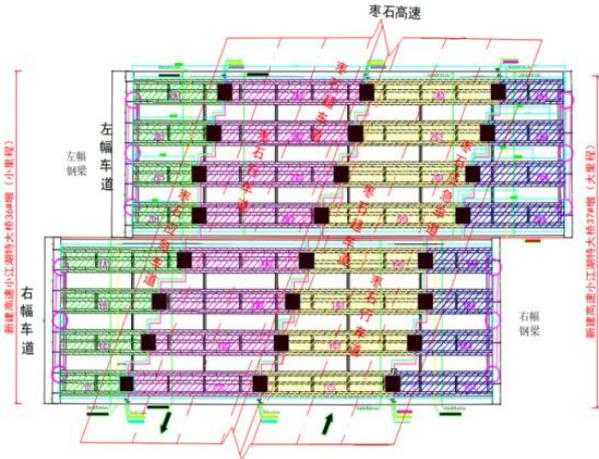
主线桥（小江湖特大桥）钢梁节段划分总平面布置图
